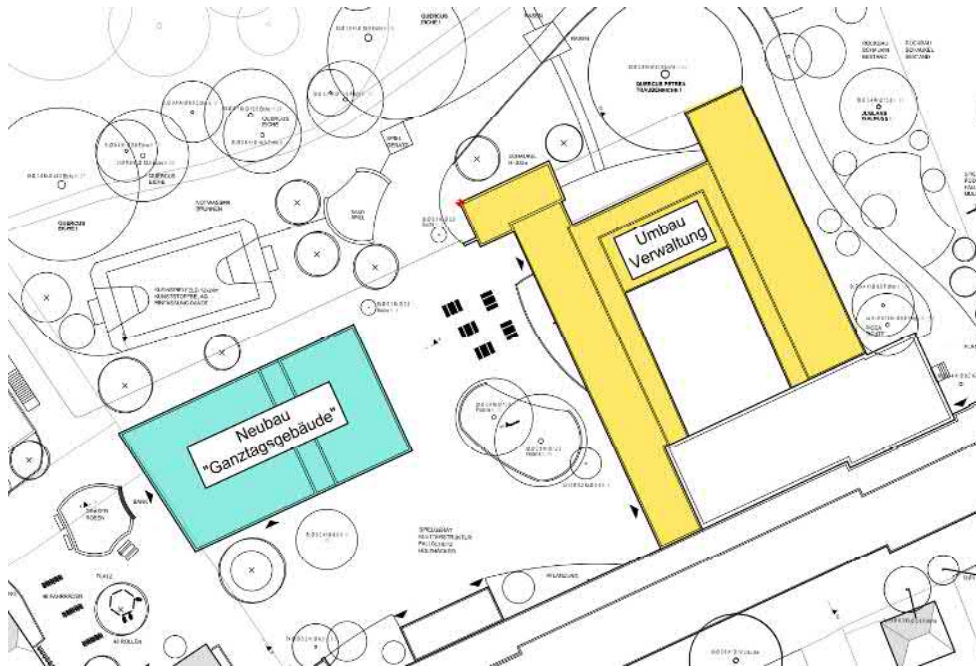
GS Arnum - Lageplan Ausschnitt
